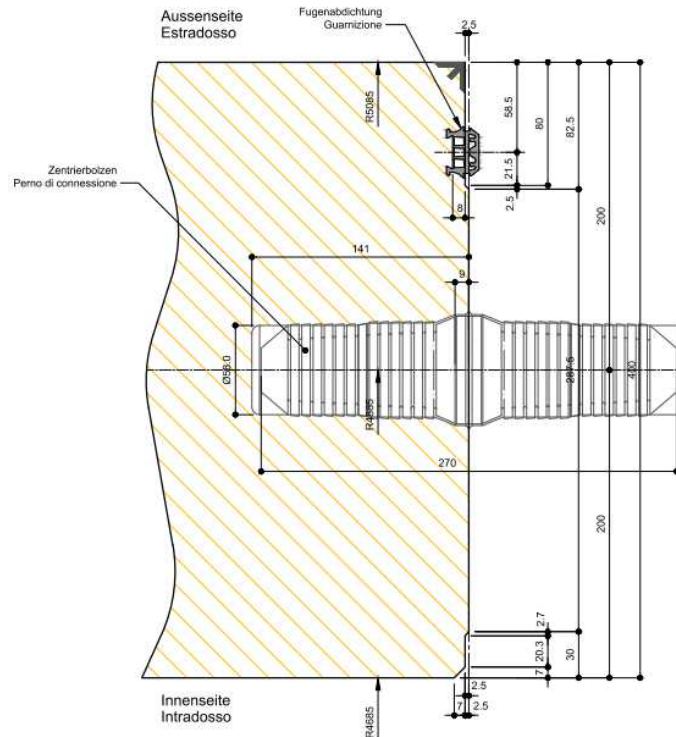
Detail eines vorfabrizierten Tübbing mit einfacher Dichtung, die zur Aussenkante verankert ist [56].
